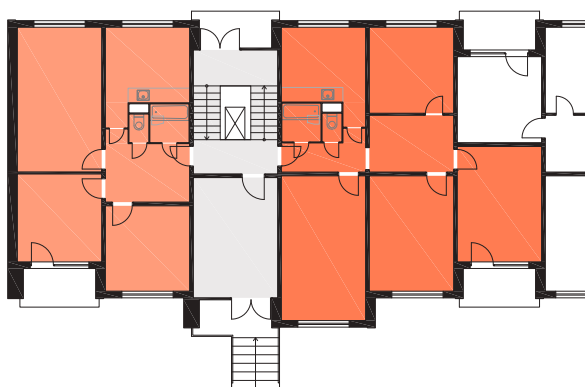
Konstrukční soustava T06B (Zdroj: panelaky.info)
